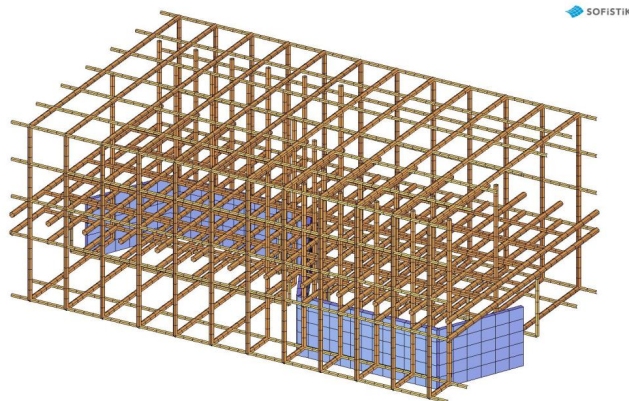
Modellierung Bewehrung - SOFISTIK
